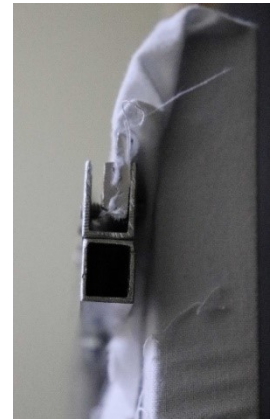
Primeiro modelo de perfis de fixação já com barra rectangular de reforço, submetido a teste
